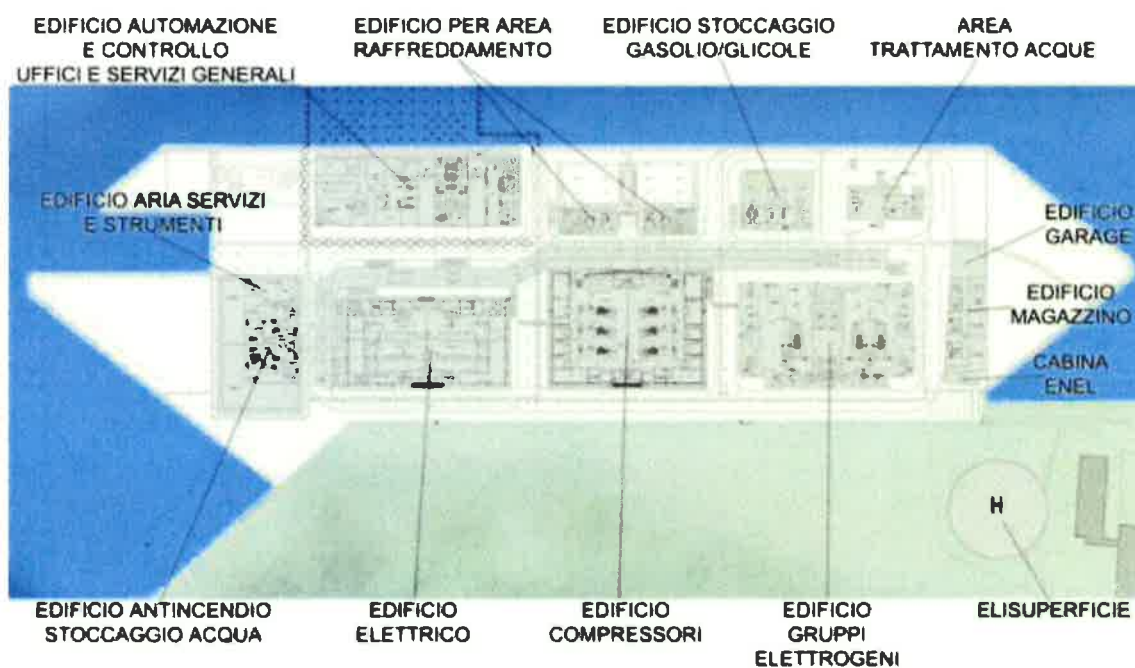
AREA IMPIANTISTICA PRINCIPALE DI CHIOGGIA SPALLA SUD
